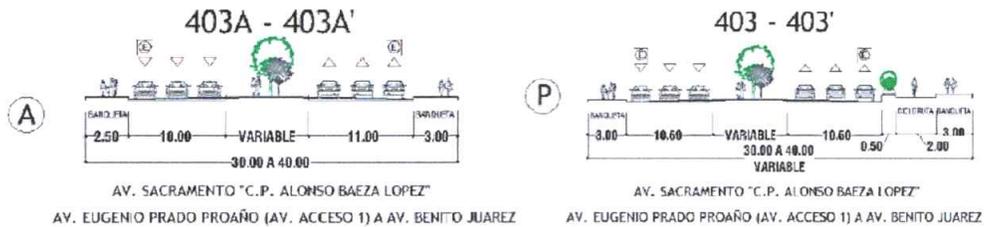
Sección vial actual y futura de la Av. Sacramento. Fuente PDU 2040 vigente.
